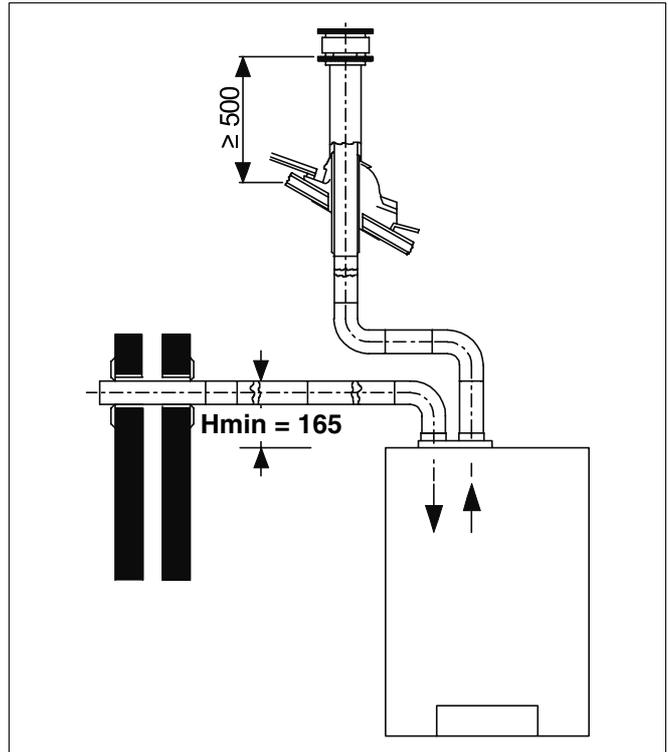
Diretta alimentazione d'aria attraverso la parete esterna e scarico dei fumi sopra il tetto (misure in mm)
